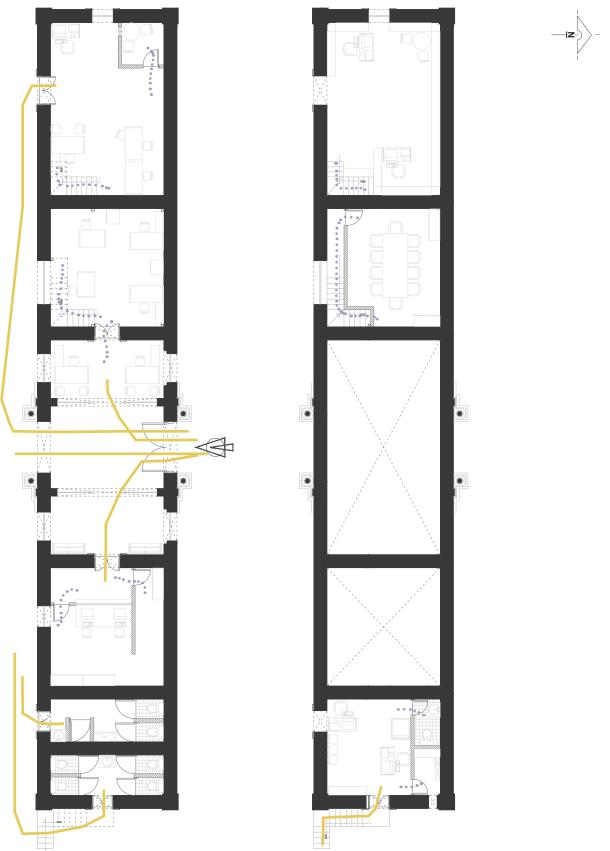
Análisis de circulación planta alta y baja módulo principal. Fuente: María Alejandra López Vivanco (2023).
